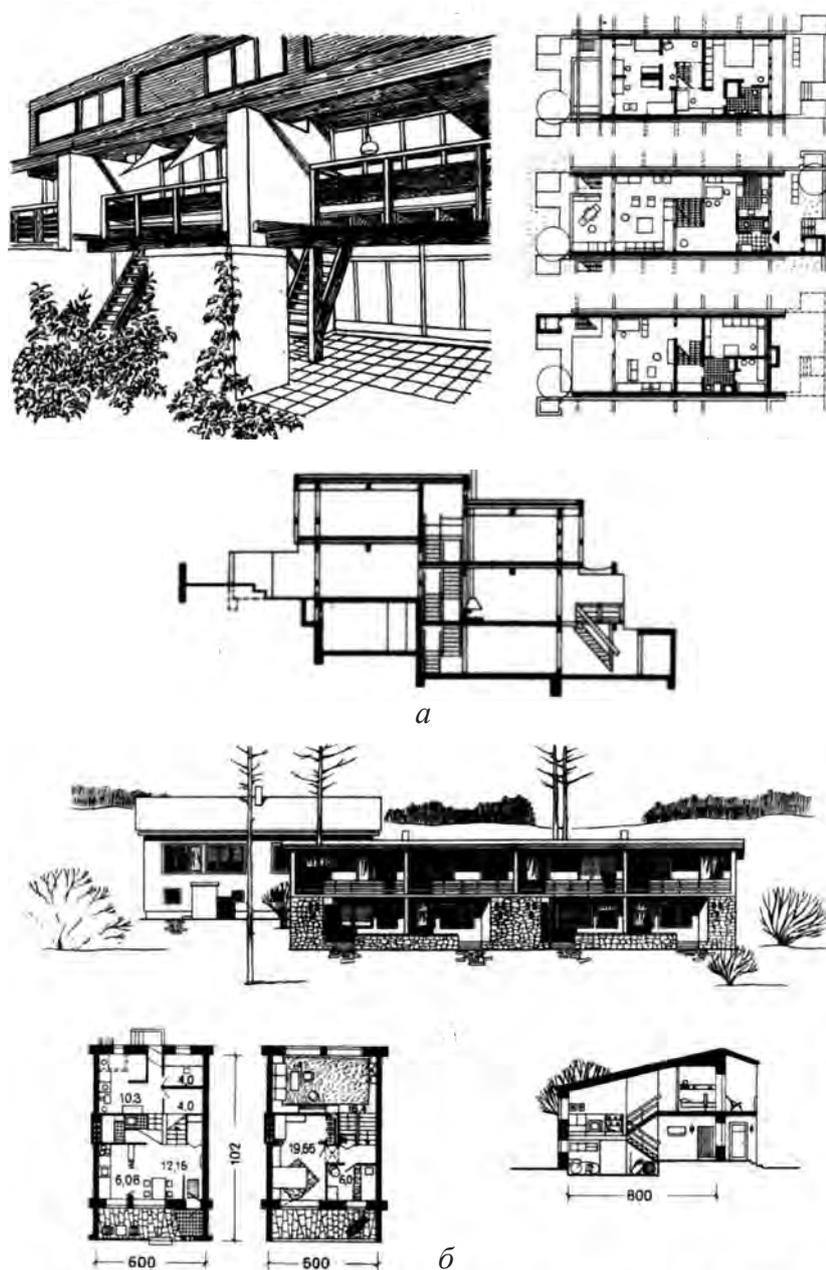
Блокированные дома с квартирами, решенными со смещением уровней помещений на пол-этажа. Общий вид зданий, планы этажей, разрезы:
